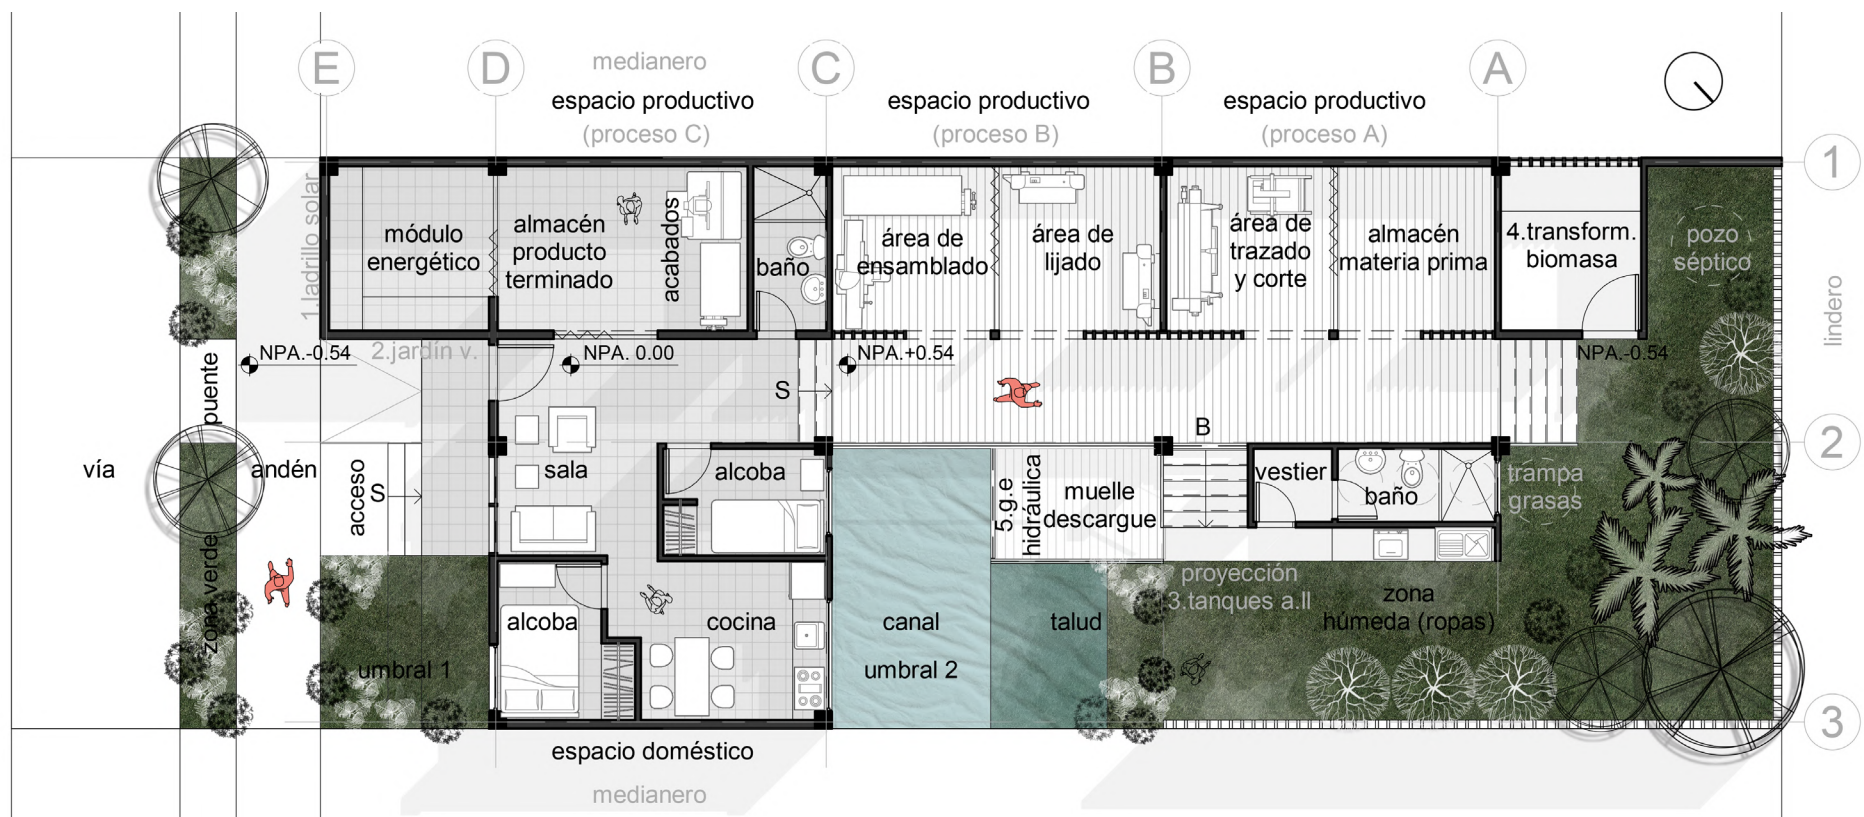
Planta arquitectónica de la propuesta para vivienda sobre el canal. Elaboración propia.
